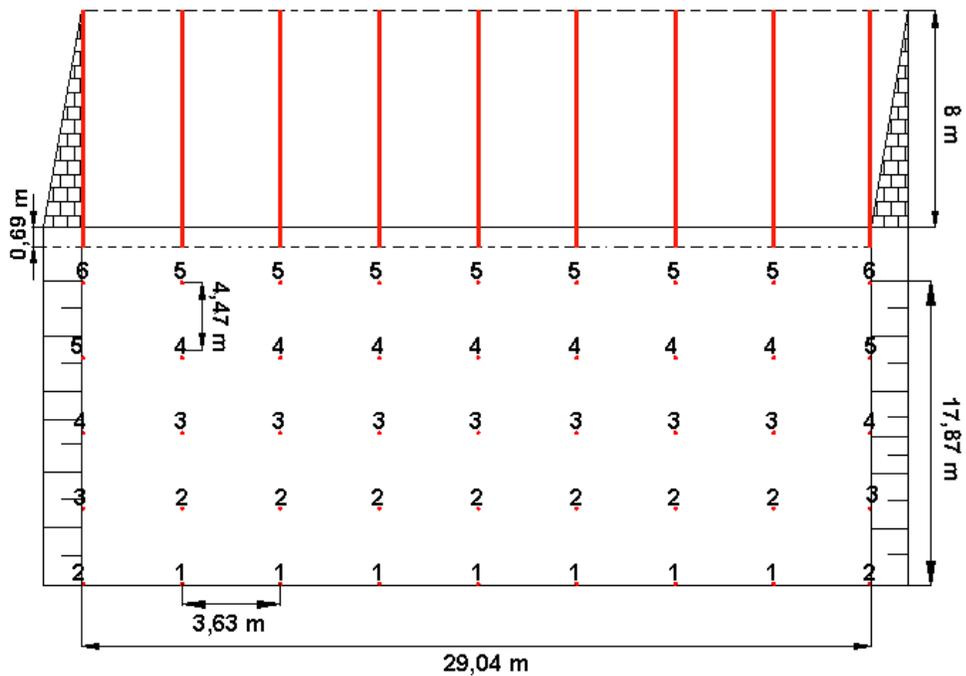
C. Perfil transversal y vista superior de la disposición de los taladros en el horizonte 1 (Bloque 20)
